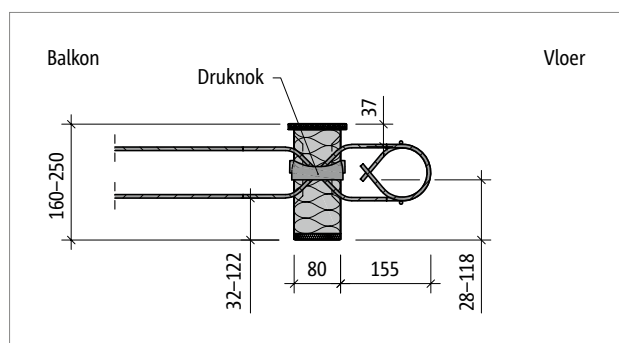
Schöck Isokorf® T type Q-E-W-V4: Zijaanzicht
